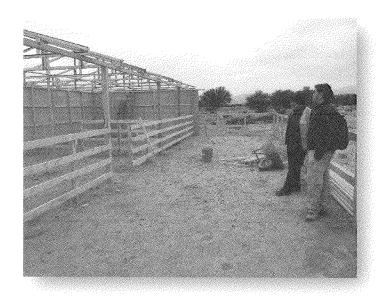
Proyecto IFP Oriel Valenzuela, Construcción de corral.
